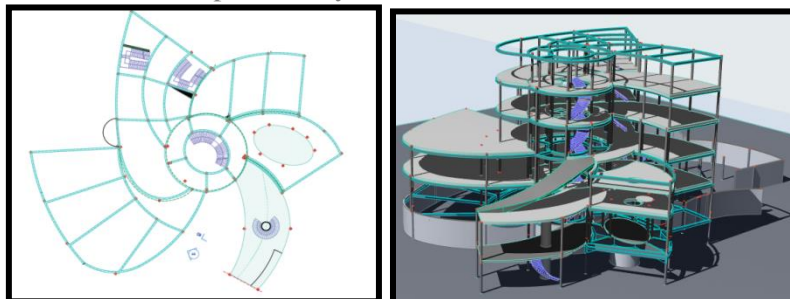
plan de structure Figure 182 : vus 3d sur la structure source (auteur)
